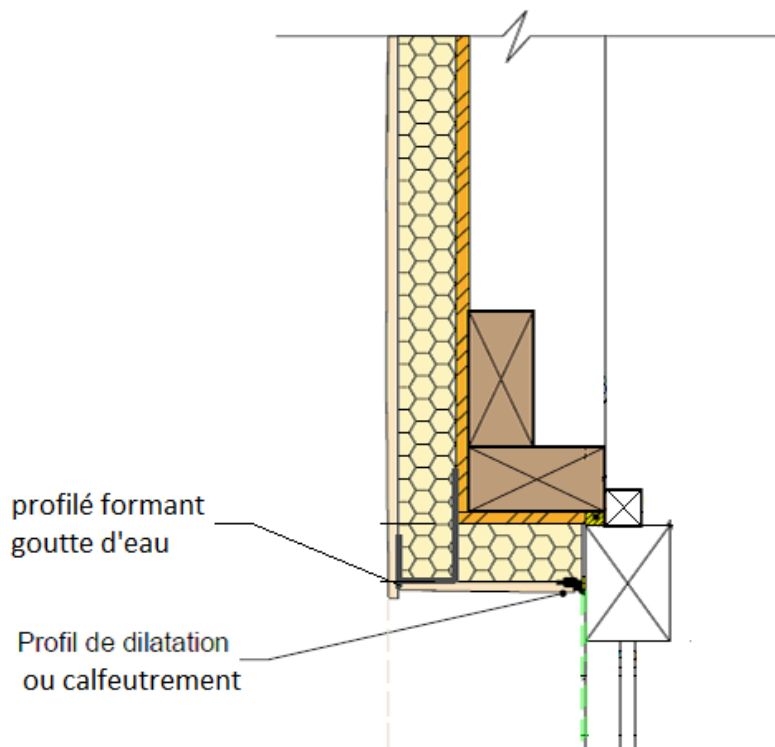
Retour d'enduit en tableau (Ee1) – coupe verticale sur linteau
